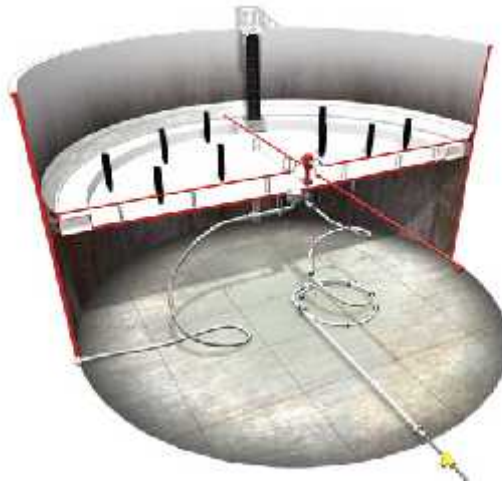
Tanque de almacenamiento de Techo Flotante Tipo Ponton⁴
